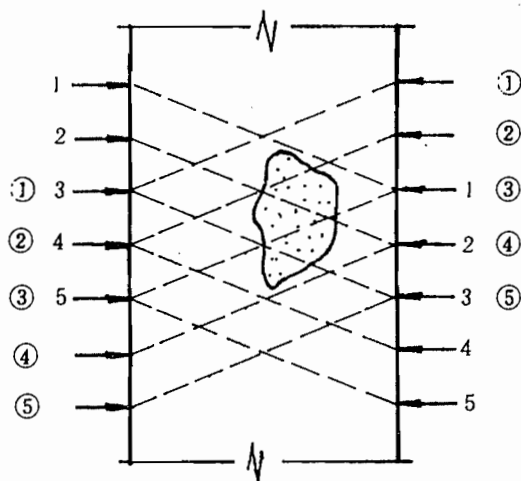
混凝土缺陷检测斜测法测点布置
